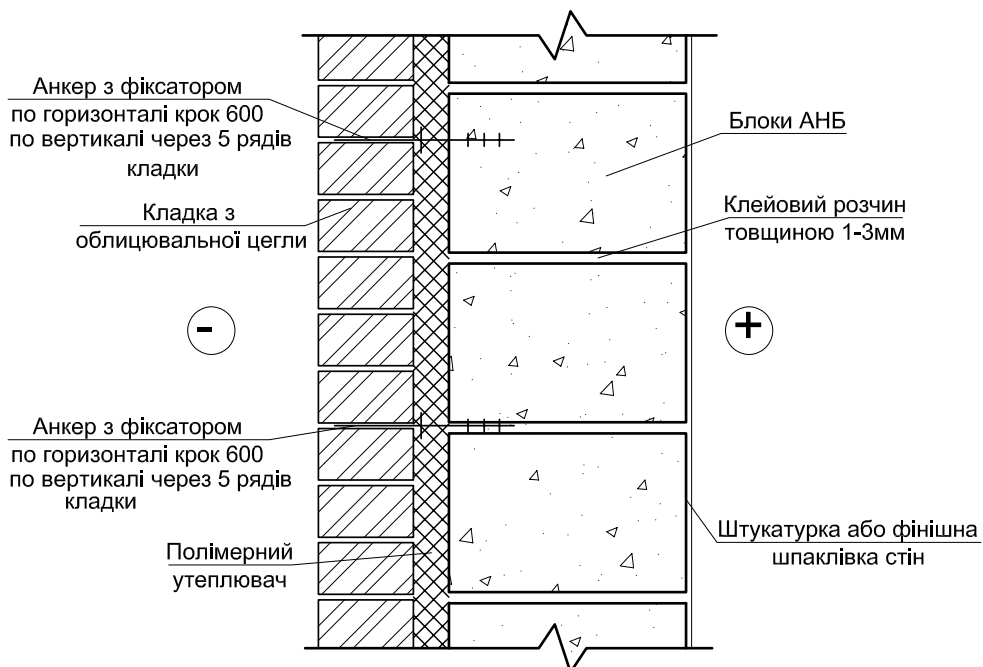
Трьохшарова стіна з утепленням і облицюванням цеглою без вентиляваного прошарку
